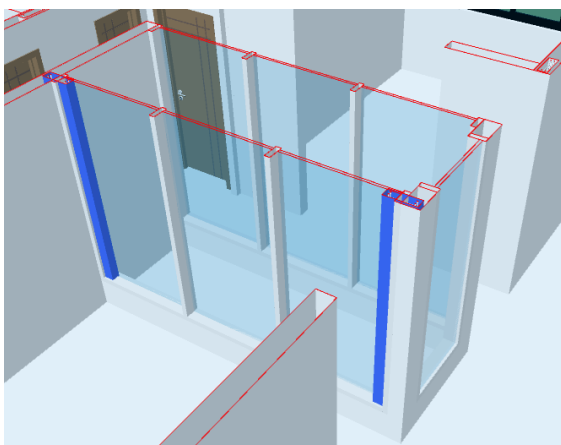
Incompatibilidade entre pilar (azul) e a arquitetura do projeto
